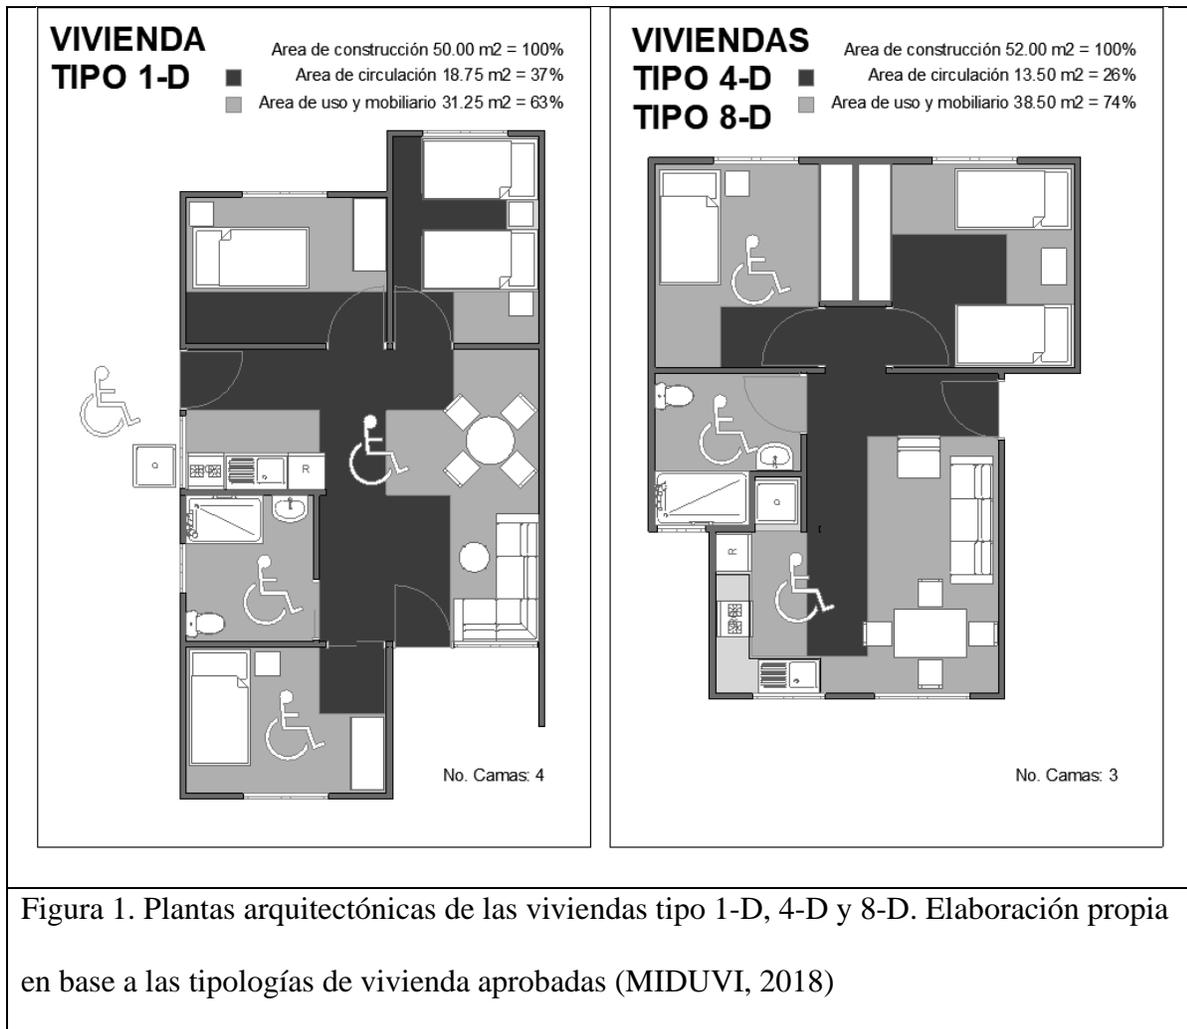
Plantas arquitectónicas de las viviendas tipo 1-D, 4-D y 8-D. Elaboración propia en base a las tipologías de vivienda aprobadas (MIDUVI, 2018)
